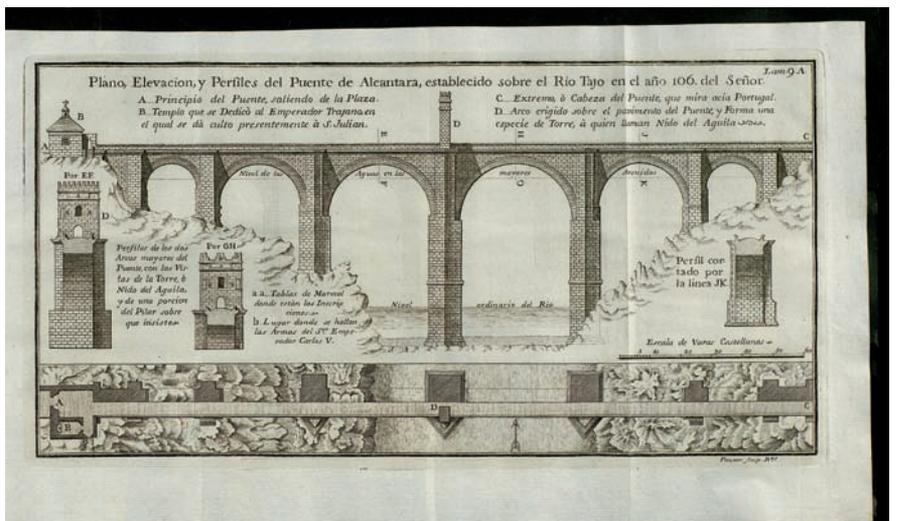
Plano del tratado de John Muller, del puente de Alcántara. Biblioteca de la Fundación Juanelo Turriano.
